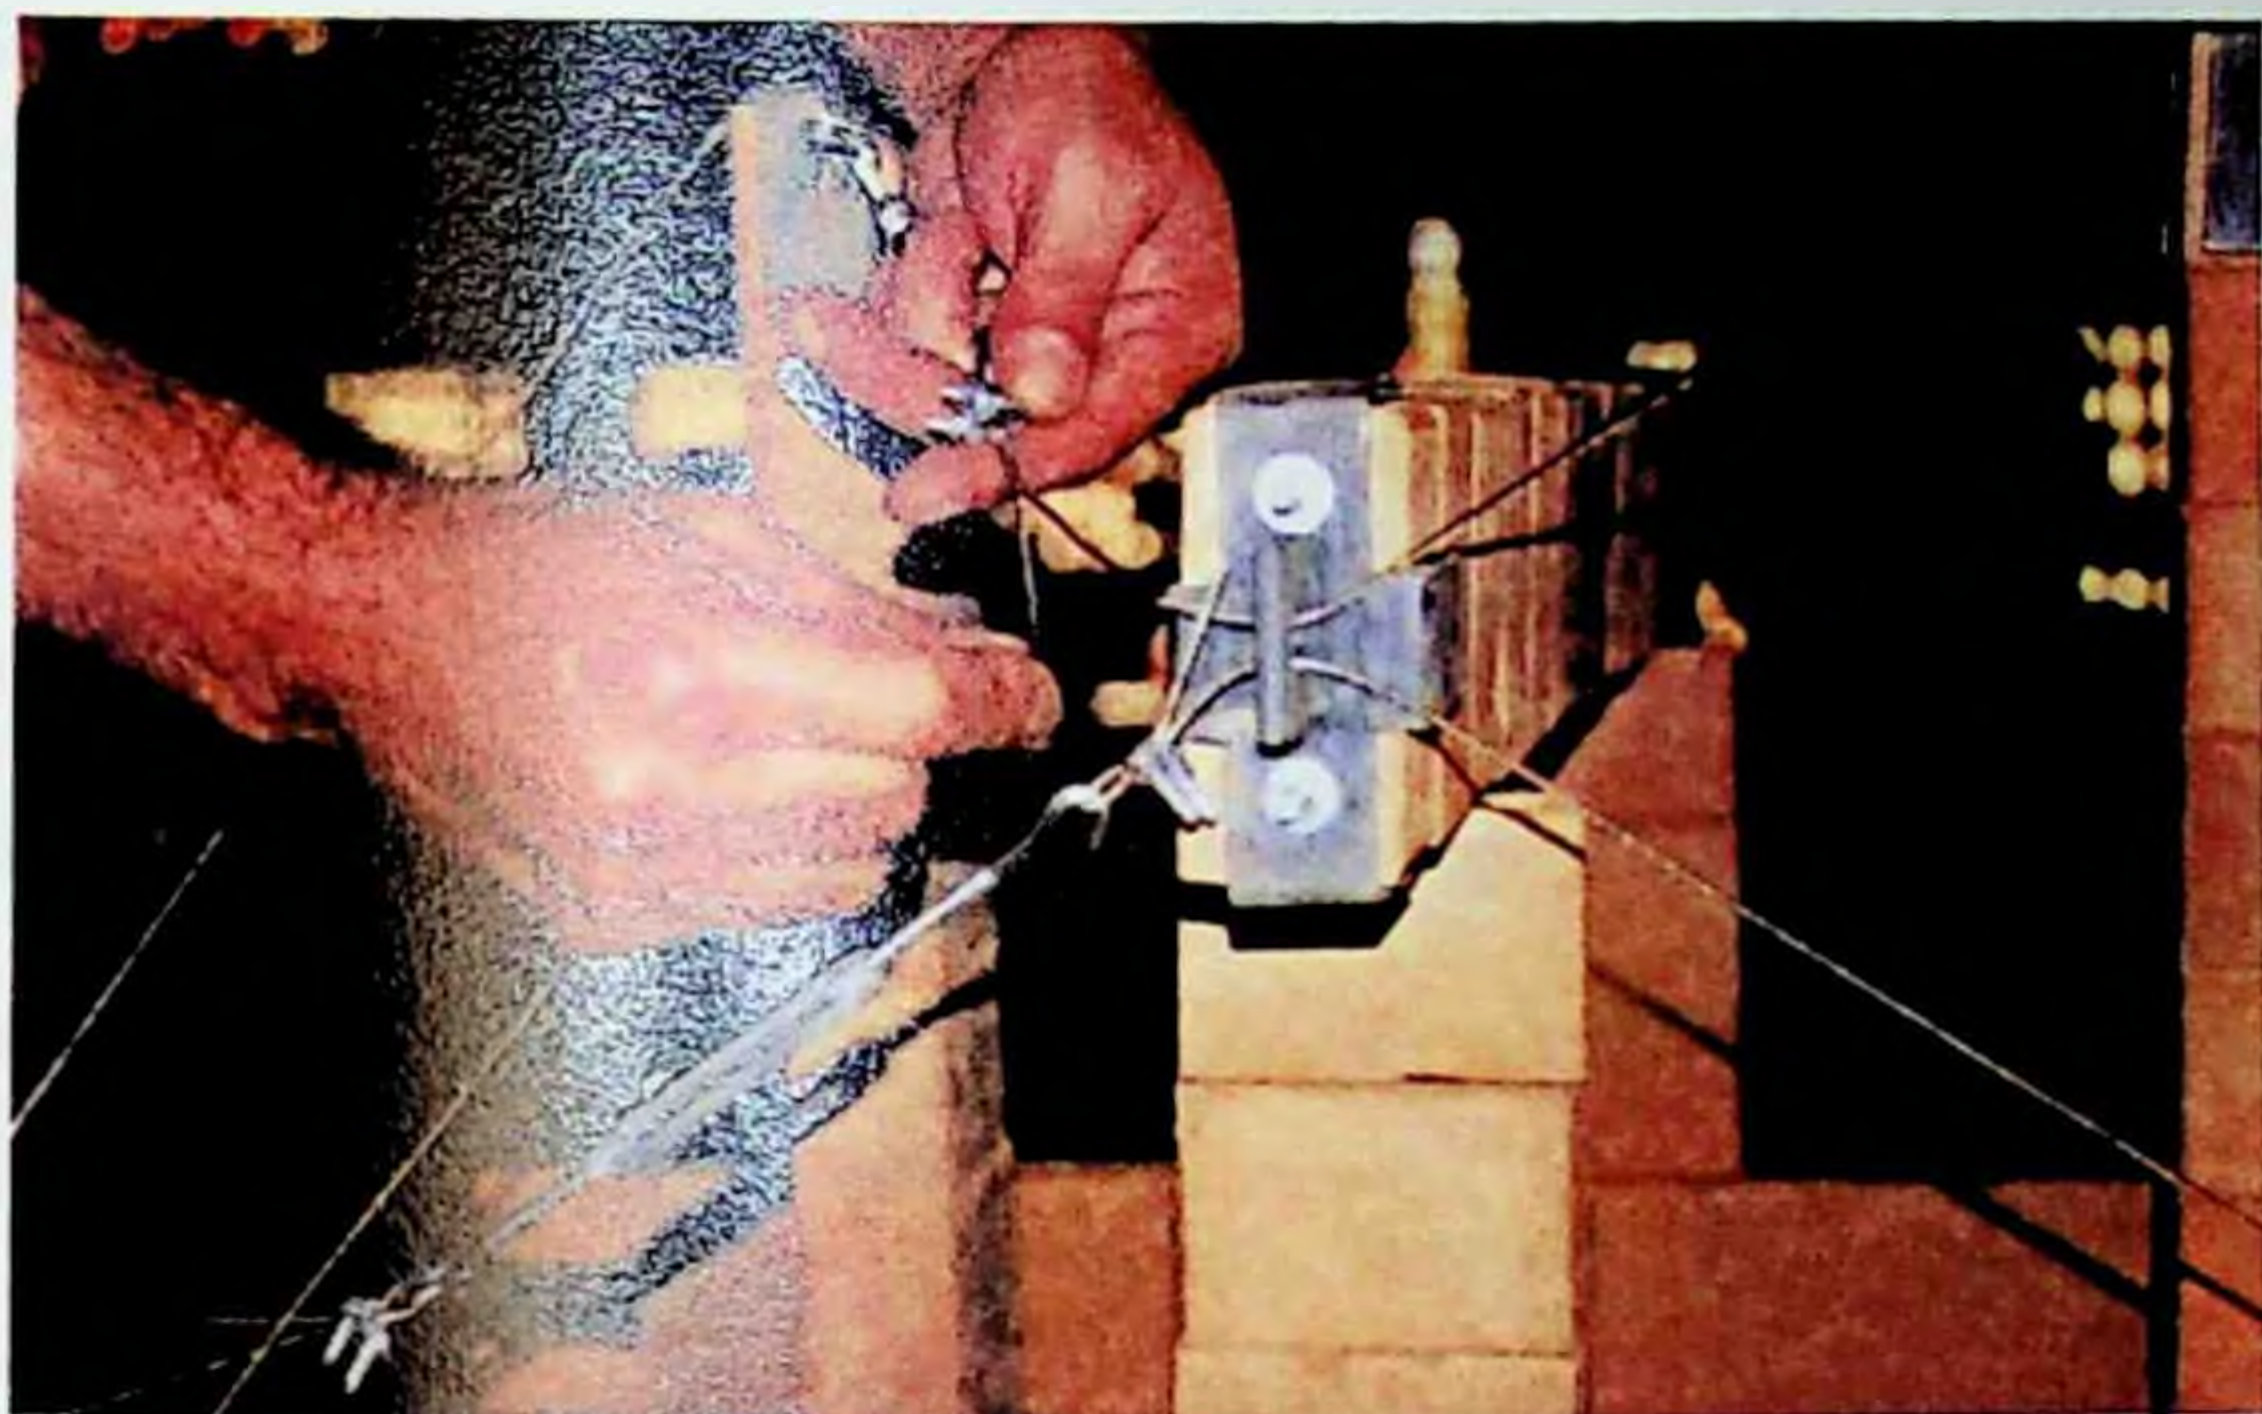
Encaixe do dispositivo metálico. Note no plano do fundo uma das barras já estabilizada.
